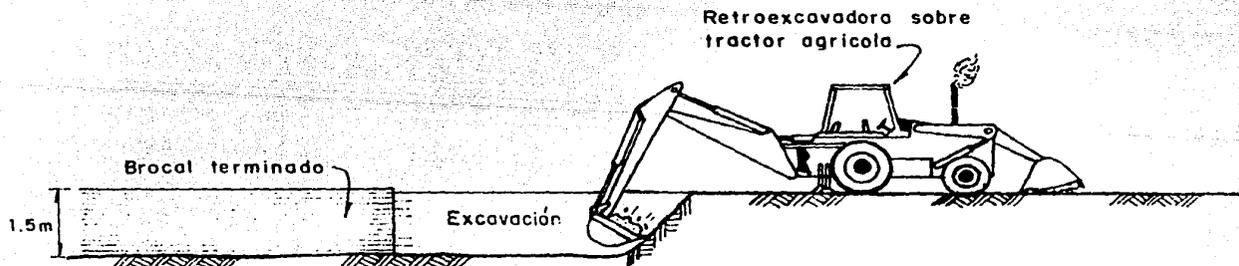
Preexcavación para la construcción de brocales para muros milán en zonas sin interferencia
